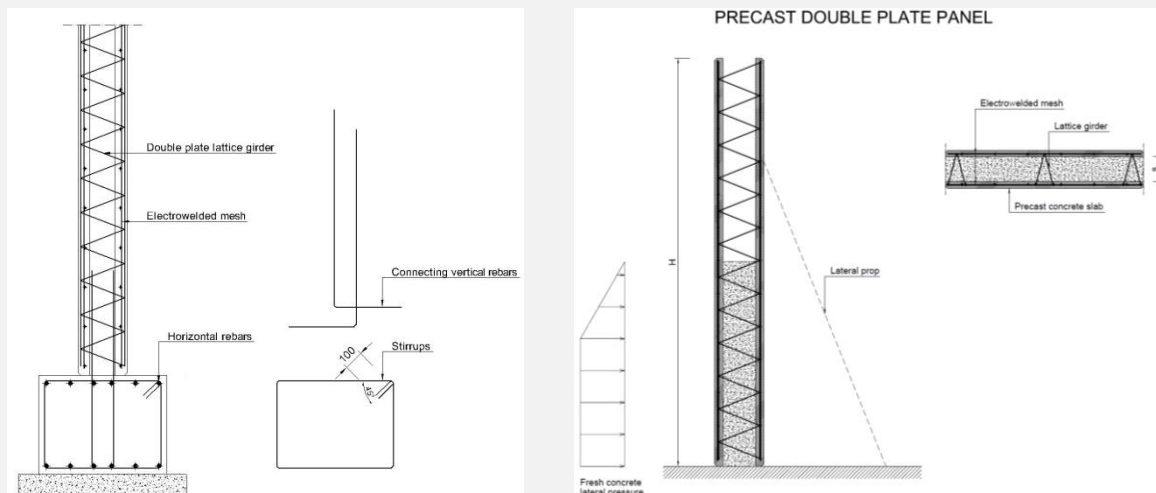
Detaliu structural tipic de prindere a pereților din b.a. de fundație (secțiune verticală).
